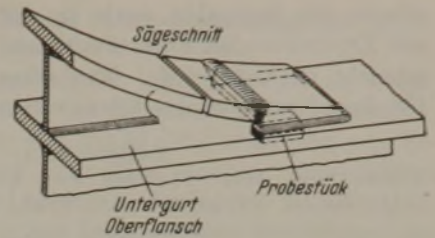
Durchführung der Schweißung bei der Verbindung von gebogener Lamelle, Ansatzstück und Oberflansch des Untergurtes.
